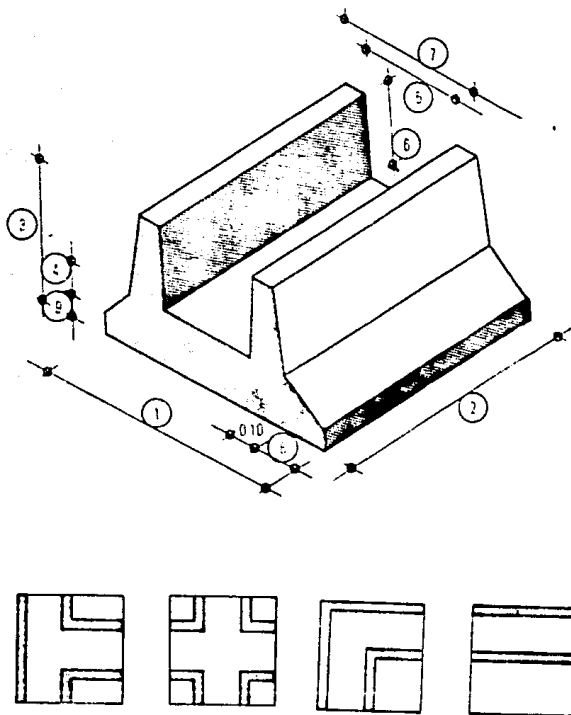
Tipos de elementos del sistema zapatrabe.
